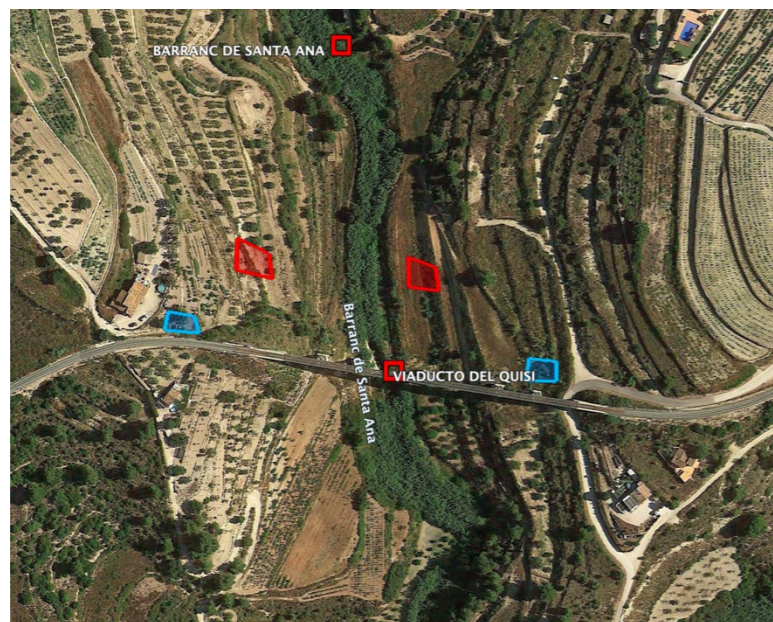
Zonas de excavación. Fuente: Elaboración propia.
